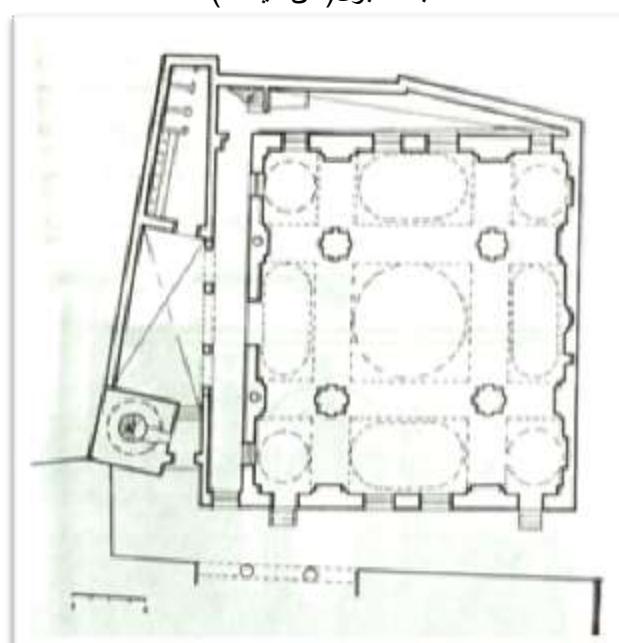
مخطط الطابق الأرضي لجامع رشيد باشا (عن الفقيه)
